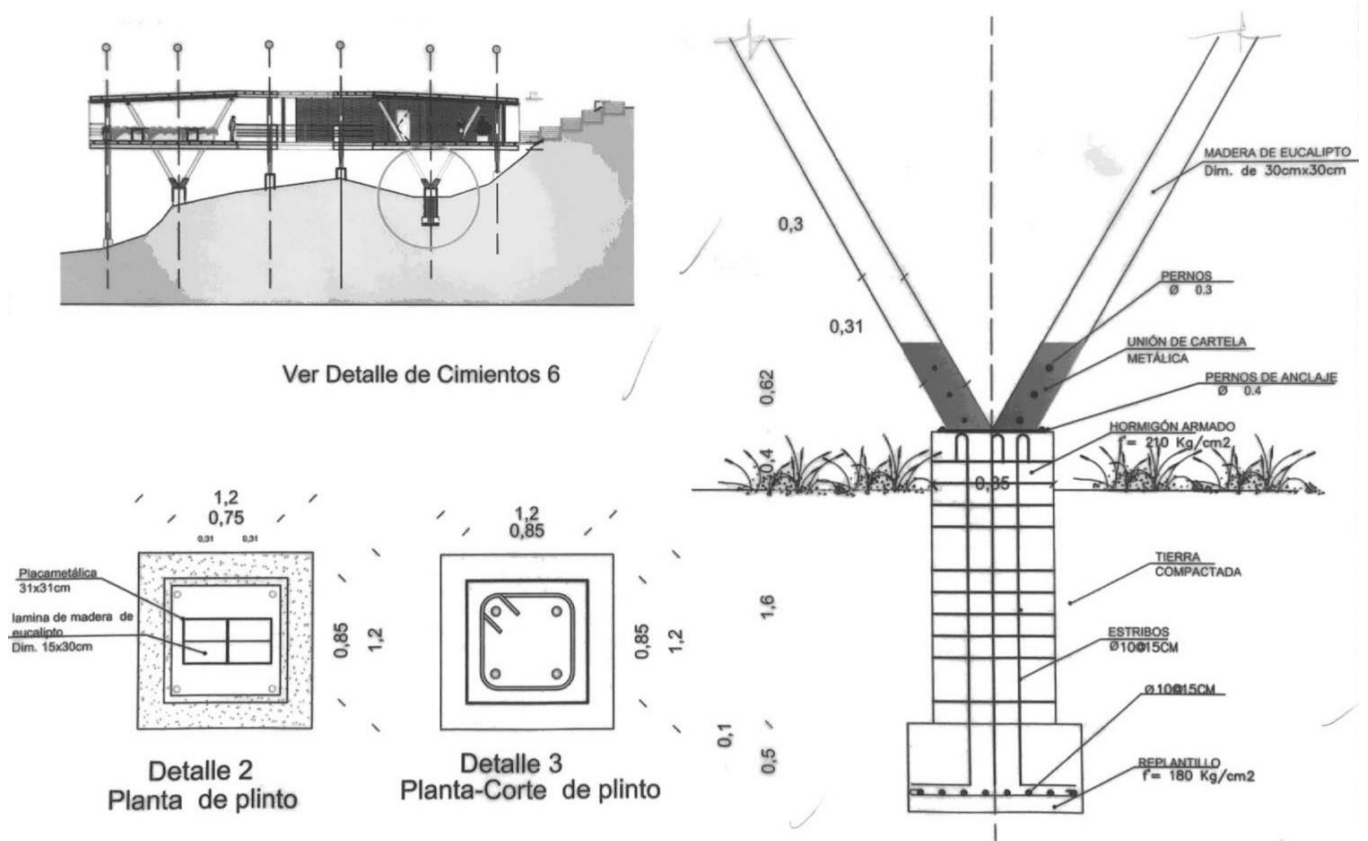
Planos de proceso constructivo del anteproyecto y la materialidad.
